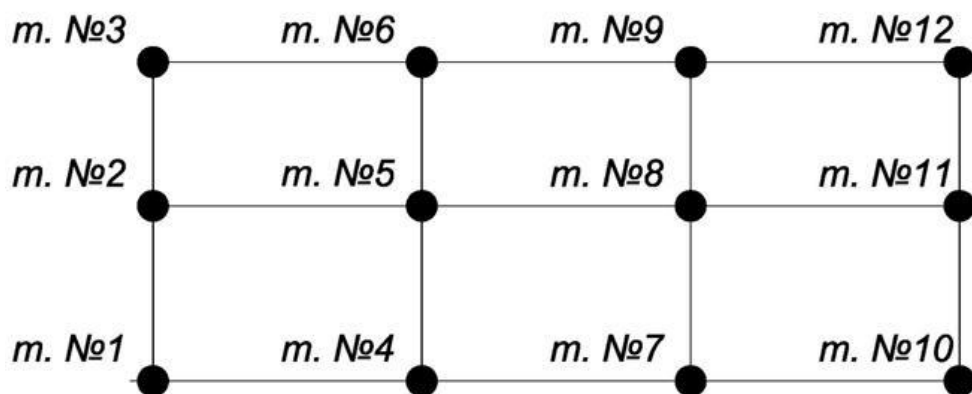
Стрижнева розрахункова схема досліджуваної будівлі. Розріз
